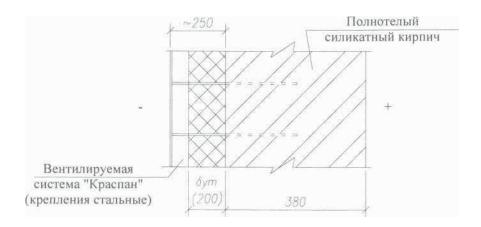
Конструкция наружной стены здания спортивно - оздоровительного центра.
